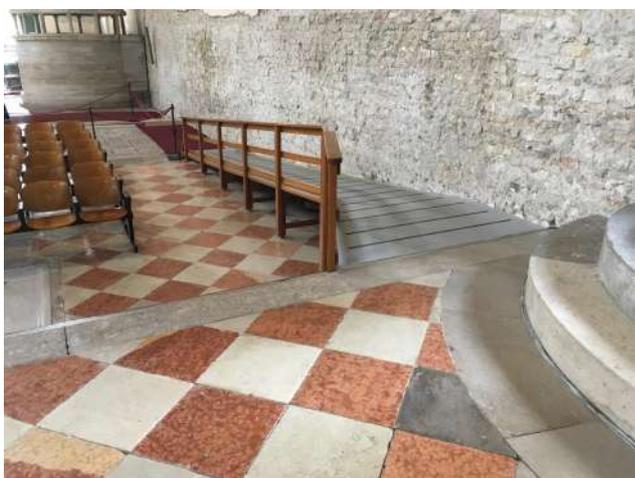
Rampa in legno con parapetto ad altezza 70 cm.
